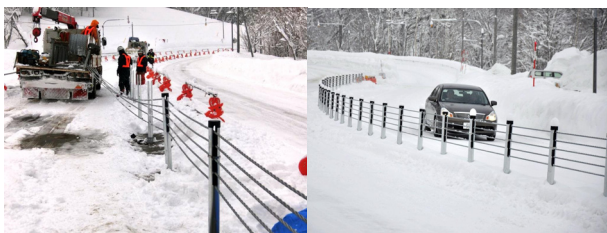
R275天北峠での施工状況（左）と施工後の状況（右）
